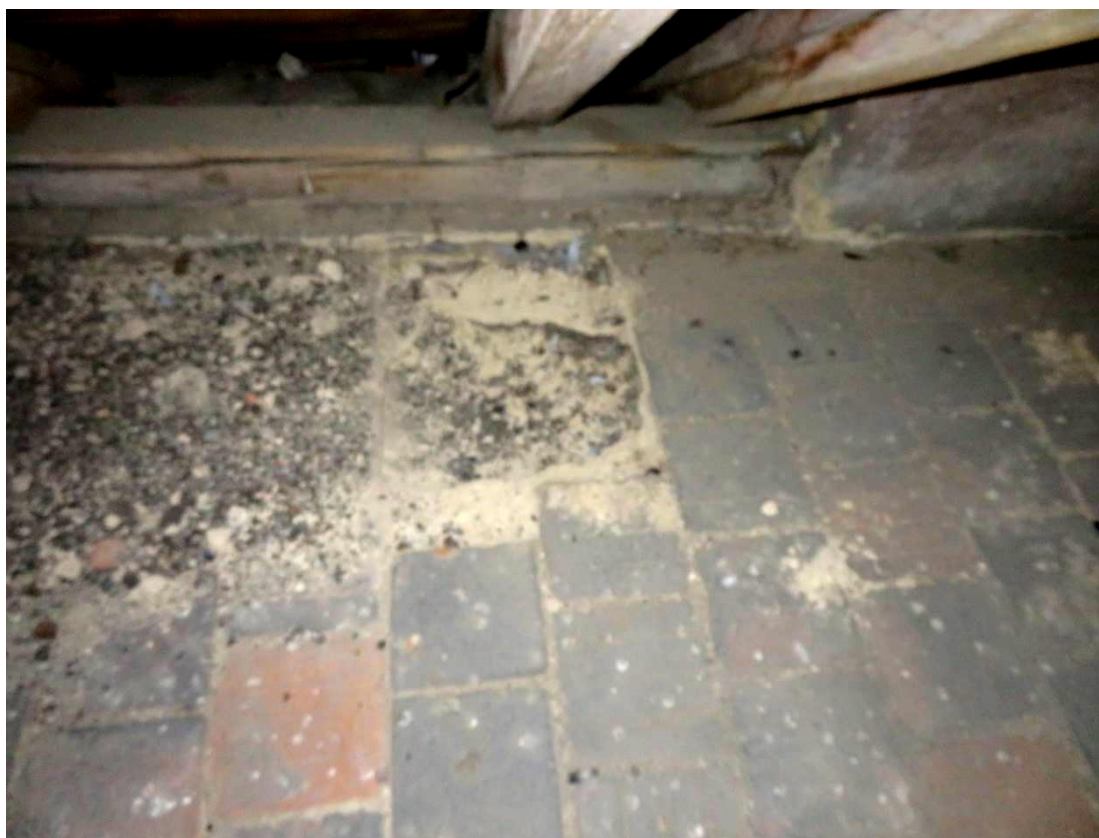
Zikova 1 – 4.NP – sonda SS29 – pohled do dutiny
